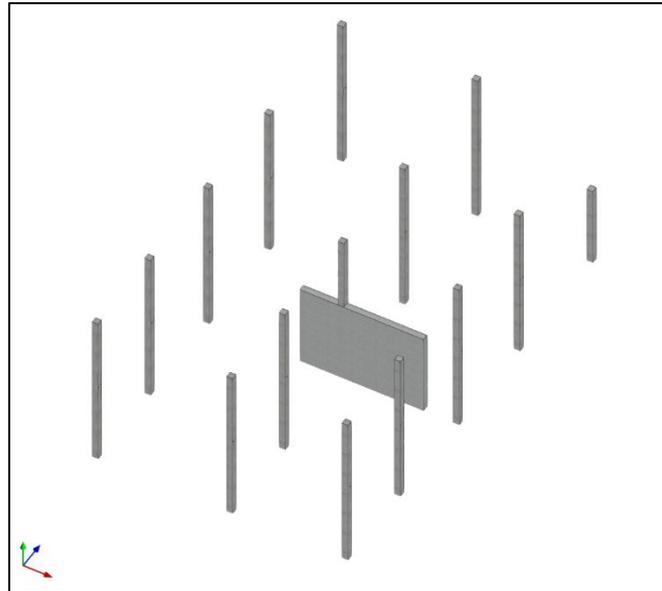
07. Recorte de pantalla, Vista 3D de los pilares y del muro en Cypecad
